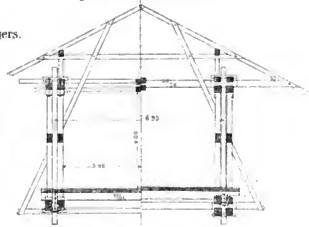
(Straßenbrücke) Längenschnitt 1:100.
